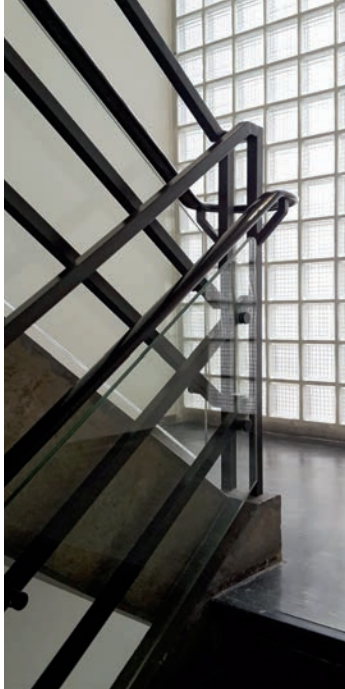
Südtreppenhaus, Nachrüstung mit Glaspaneelen, 2017
